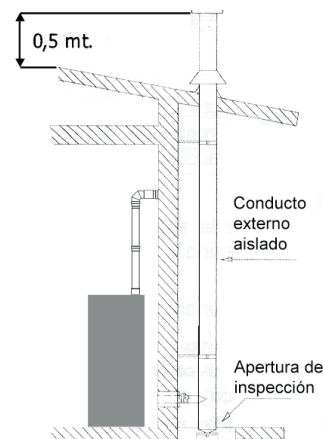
conexión a un conducto externo con tubo aislado o pared doble
